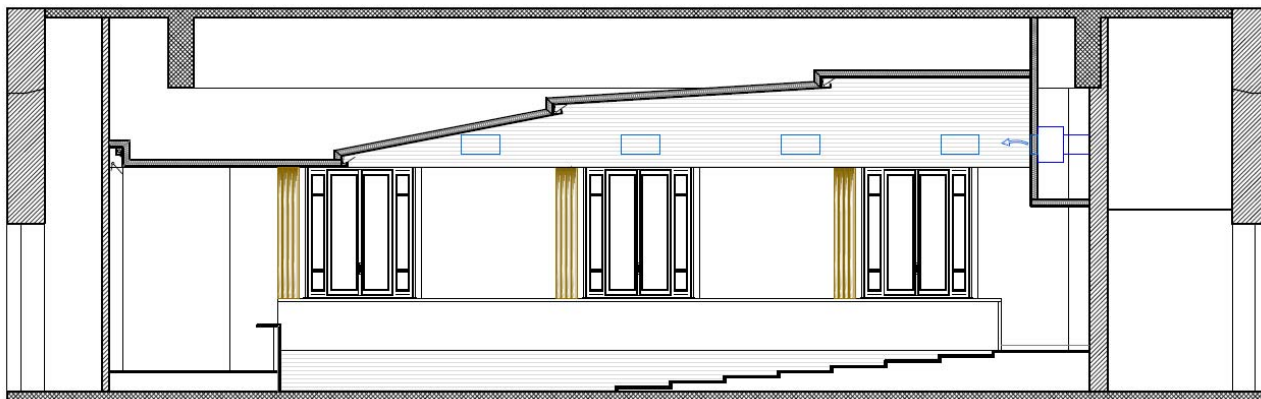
Sezione longitudinale – andamento del controsoffitto
